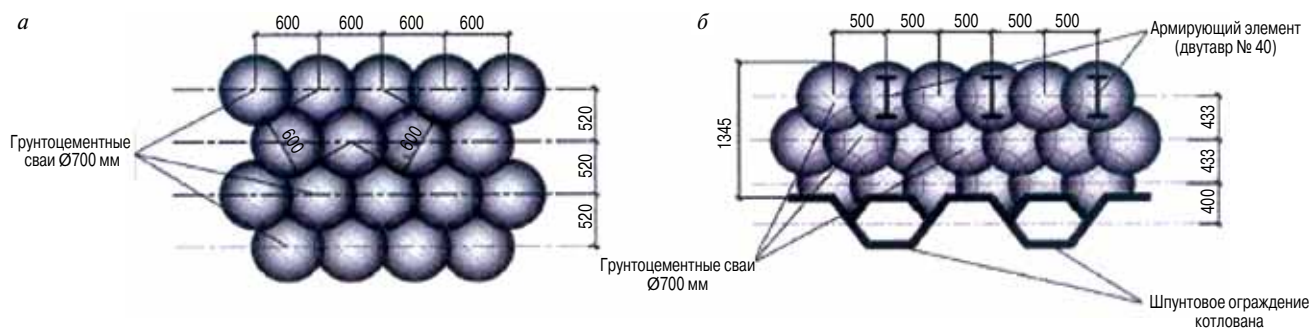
Схема расположения грунтоцементных элементов. а – распорная грунтоцементная плита; б – ограждающая стена
